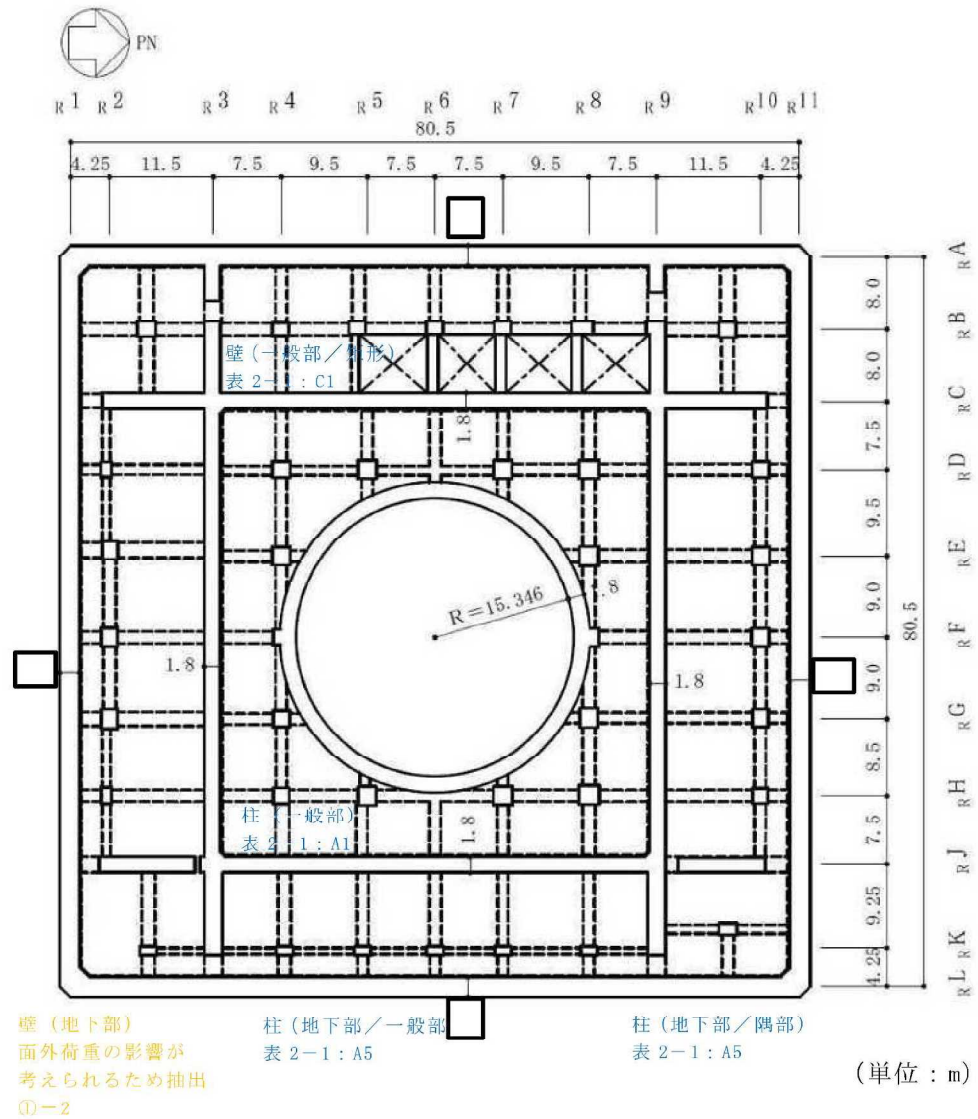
5号機原子炉建屋の概略平面図 (B3F, T.M.S.L. -10.1m) (2/9)
